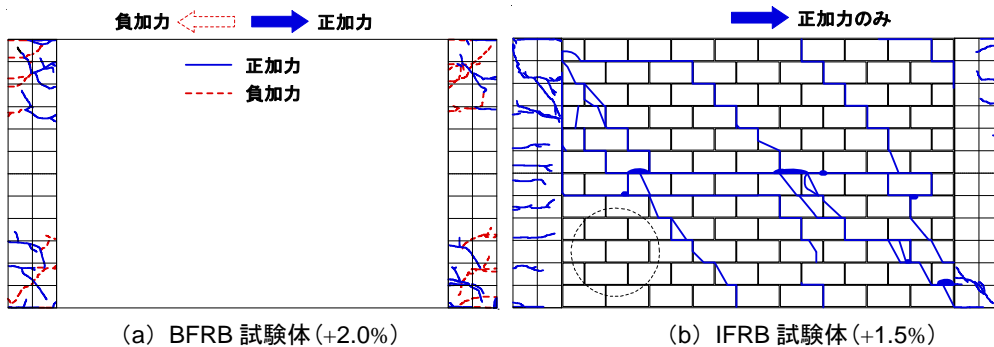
最終ひび割れ計測時のひび割れ状況
